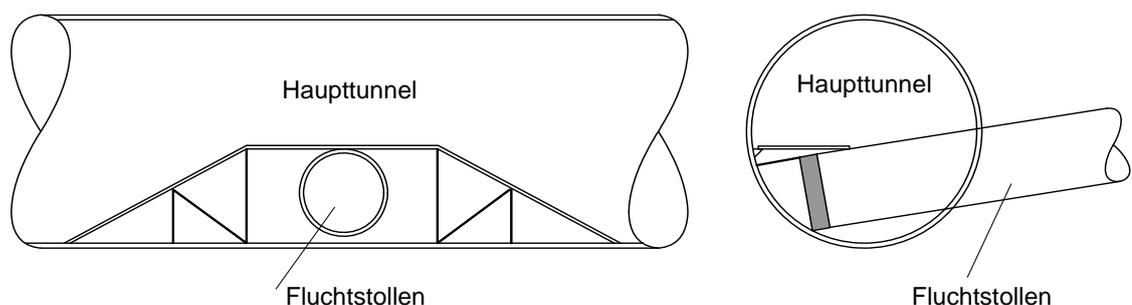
Rampe zur Aufrechterhaltung des Bauverkehrs im Haupttunnel
